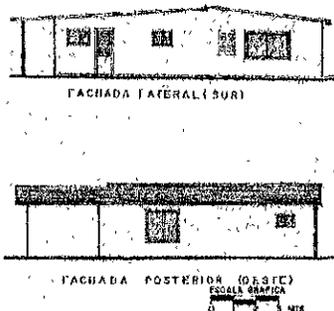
Fachadas lateral (Sur) y posterior (Oeste), caso 13.
